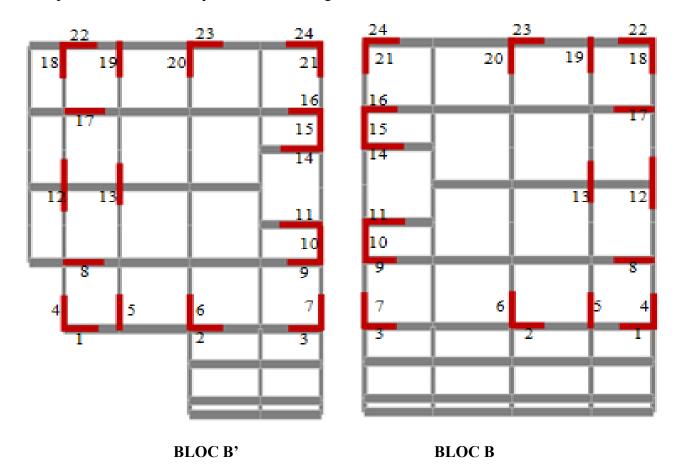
Disposition des voiles pour les blocs B et B'.
